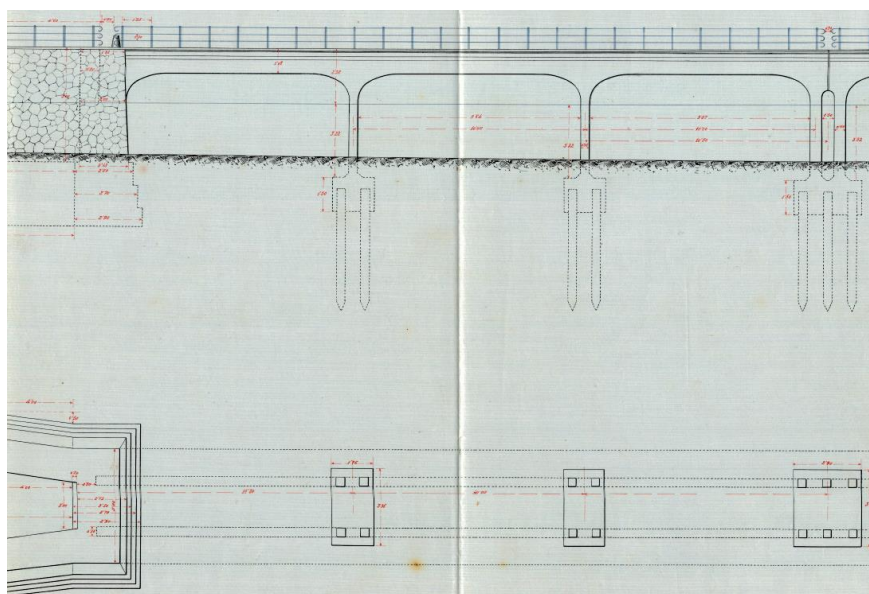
Elevación lateral puente 1922 (Archivo Histórico, 2019).
